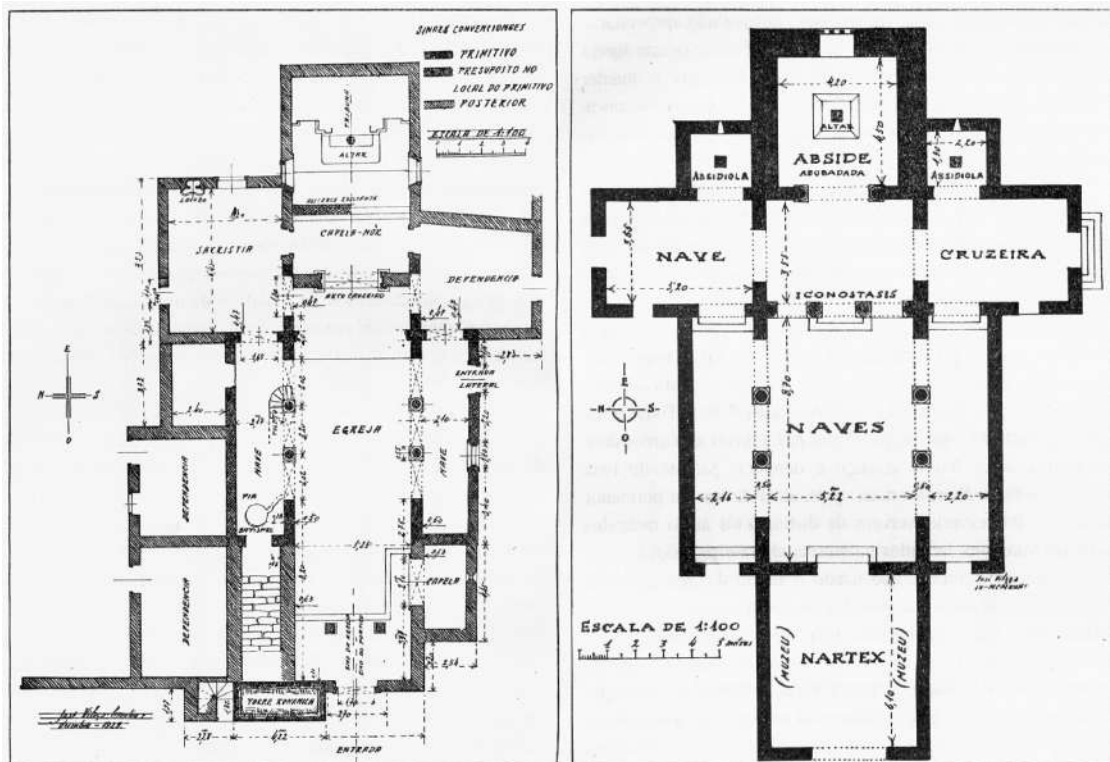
Planta de Lourosa antes y después de su restauración (Barreiros, 1934).
